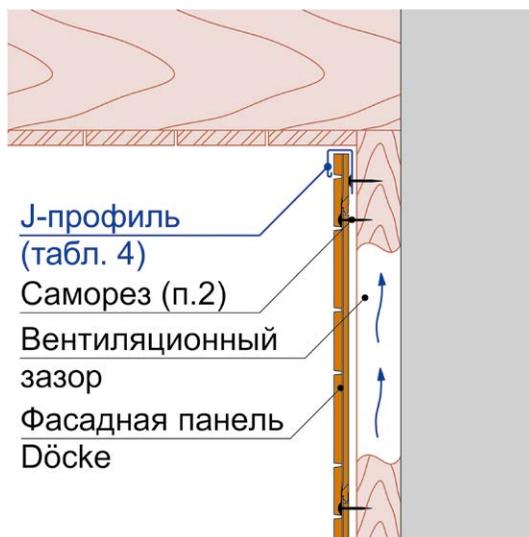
Примыкание фасадных панелей Döcke к горизонтальной поверхности
